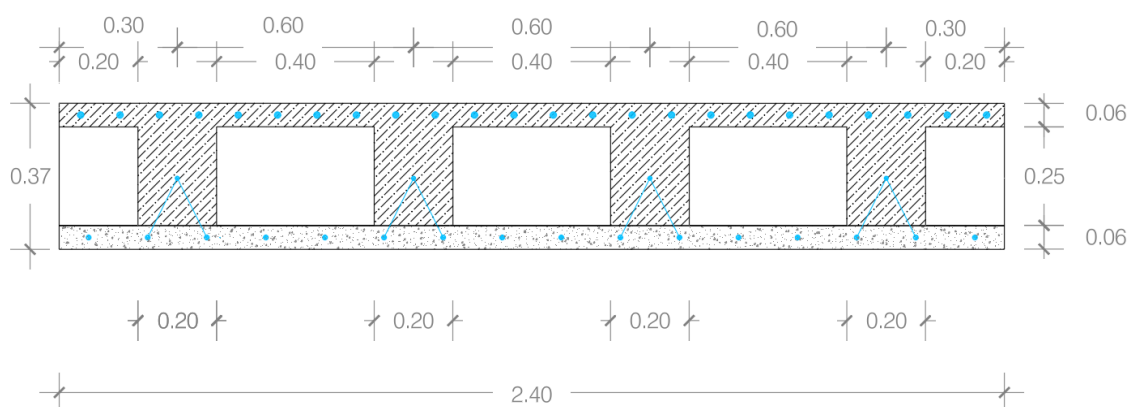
Solução da pré-laje aligeirada de vão extremo
